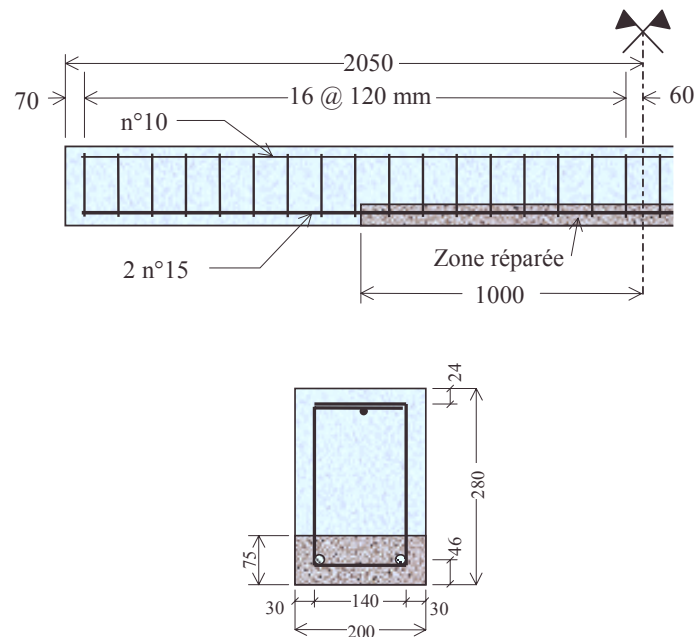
Coupe type et armatures des poutres (dimensions en mm)
